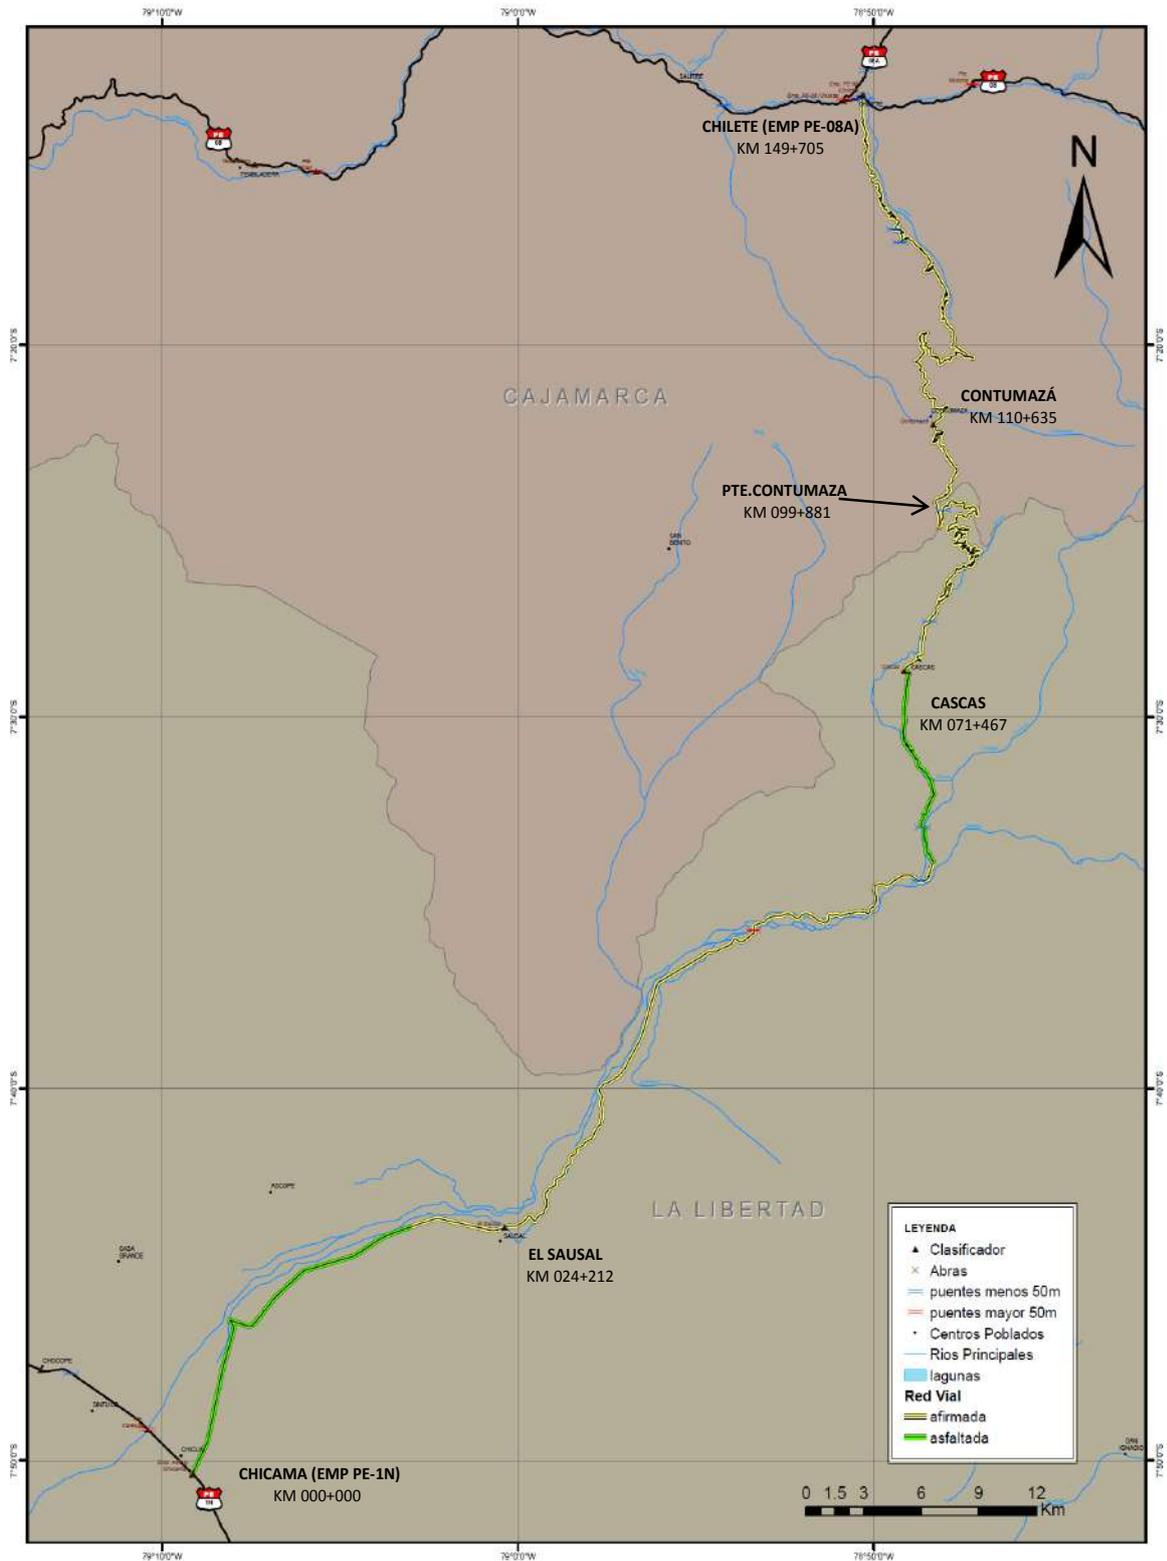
Plano de ubicación del Puente Bailey Contumazá
